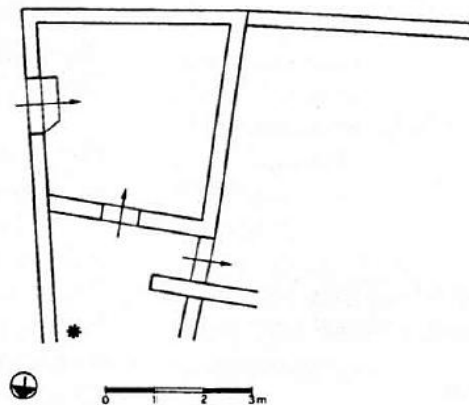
Schematischer Grundriss des römischen Gebäudes, beachte Nordpfeil.
